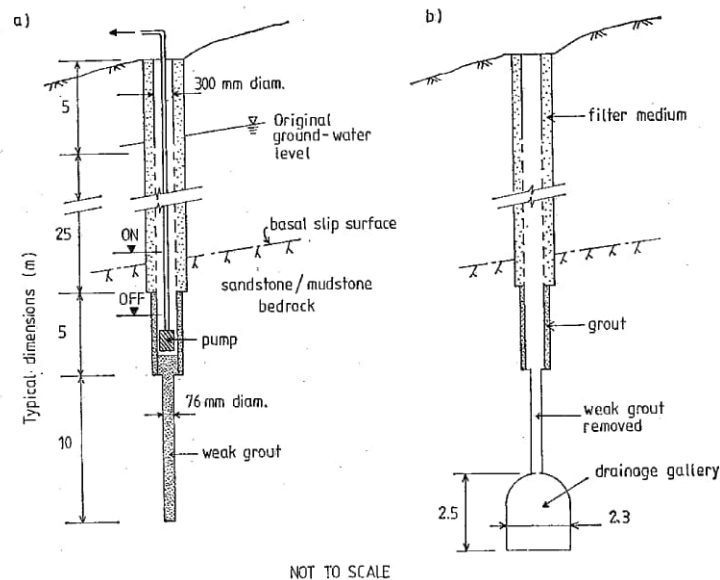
Secciones de los pozos drenantes empleados inicialmente como bombeos en el deslizamiento de Taren, conectados en fase final con galería de drenaje (Fuente: Hutchinson, 1984)
